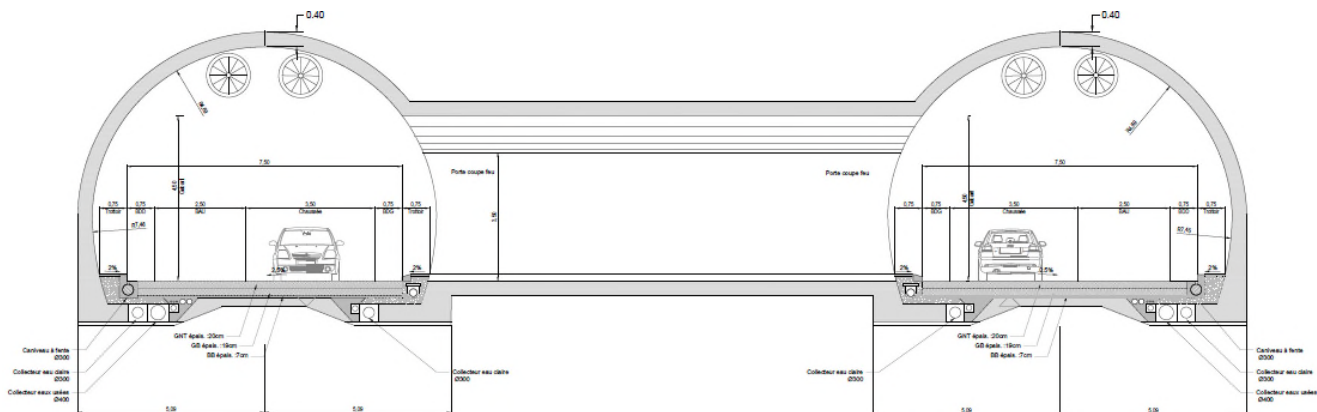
Coupe du bitube tunnel Sud avec rameau de jonction pour véhicules de service
